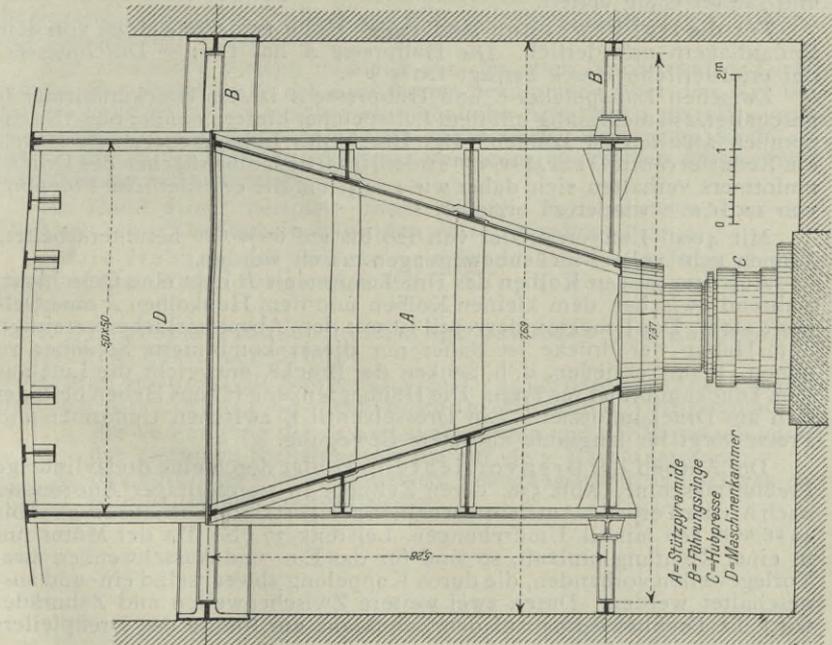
Kammer im Drehfeiler mit Drehzapfen.
